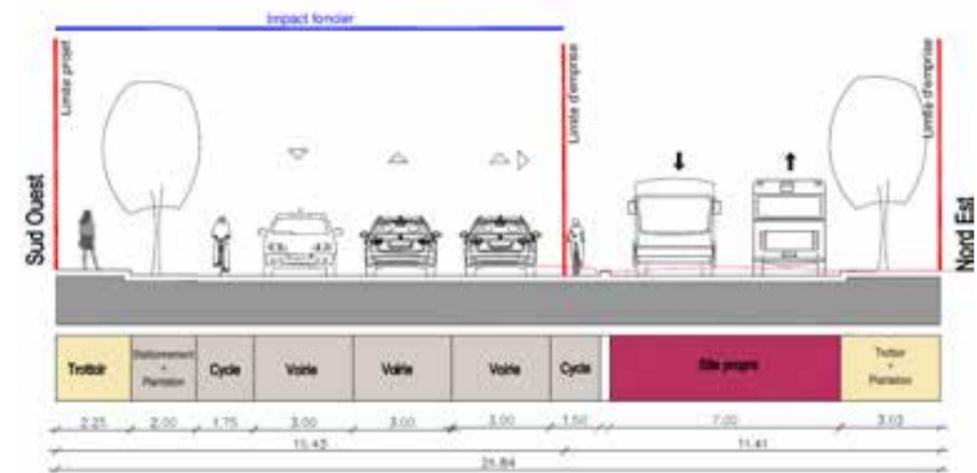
Coupe type en section courante sur le boulevard du Général Delambre
